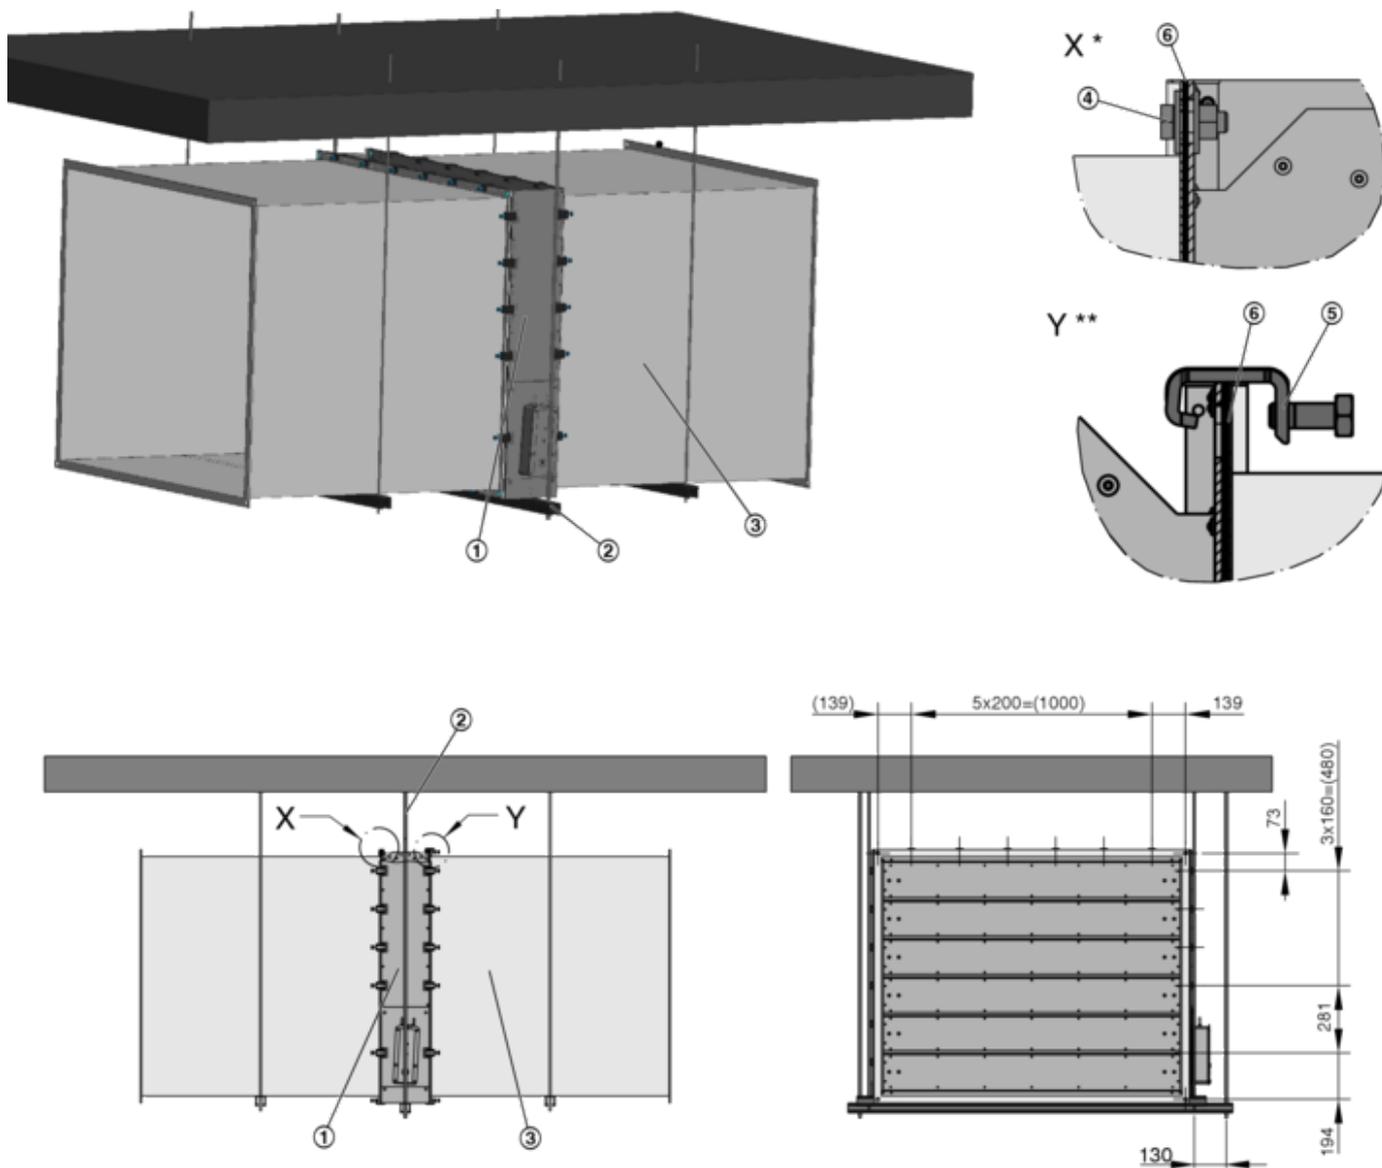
Einbau in einer horizontalen Entrauchungsleitung
